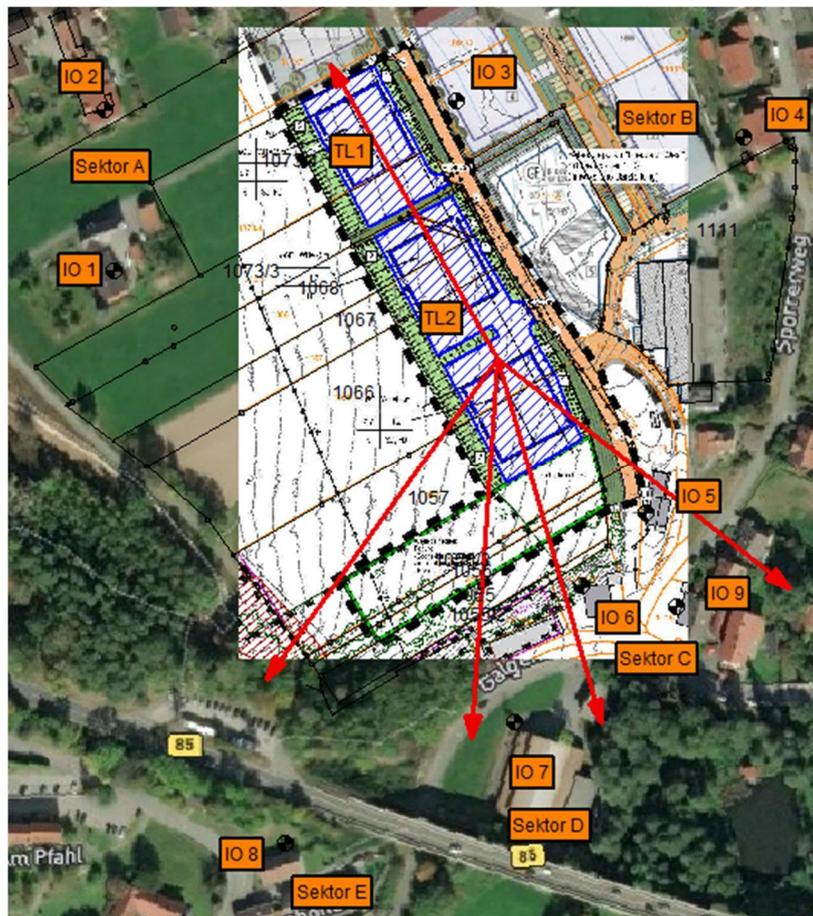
Lageplan mit Kennzeichnung der Immissionsorte IO 1 – IO 9
